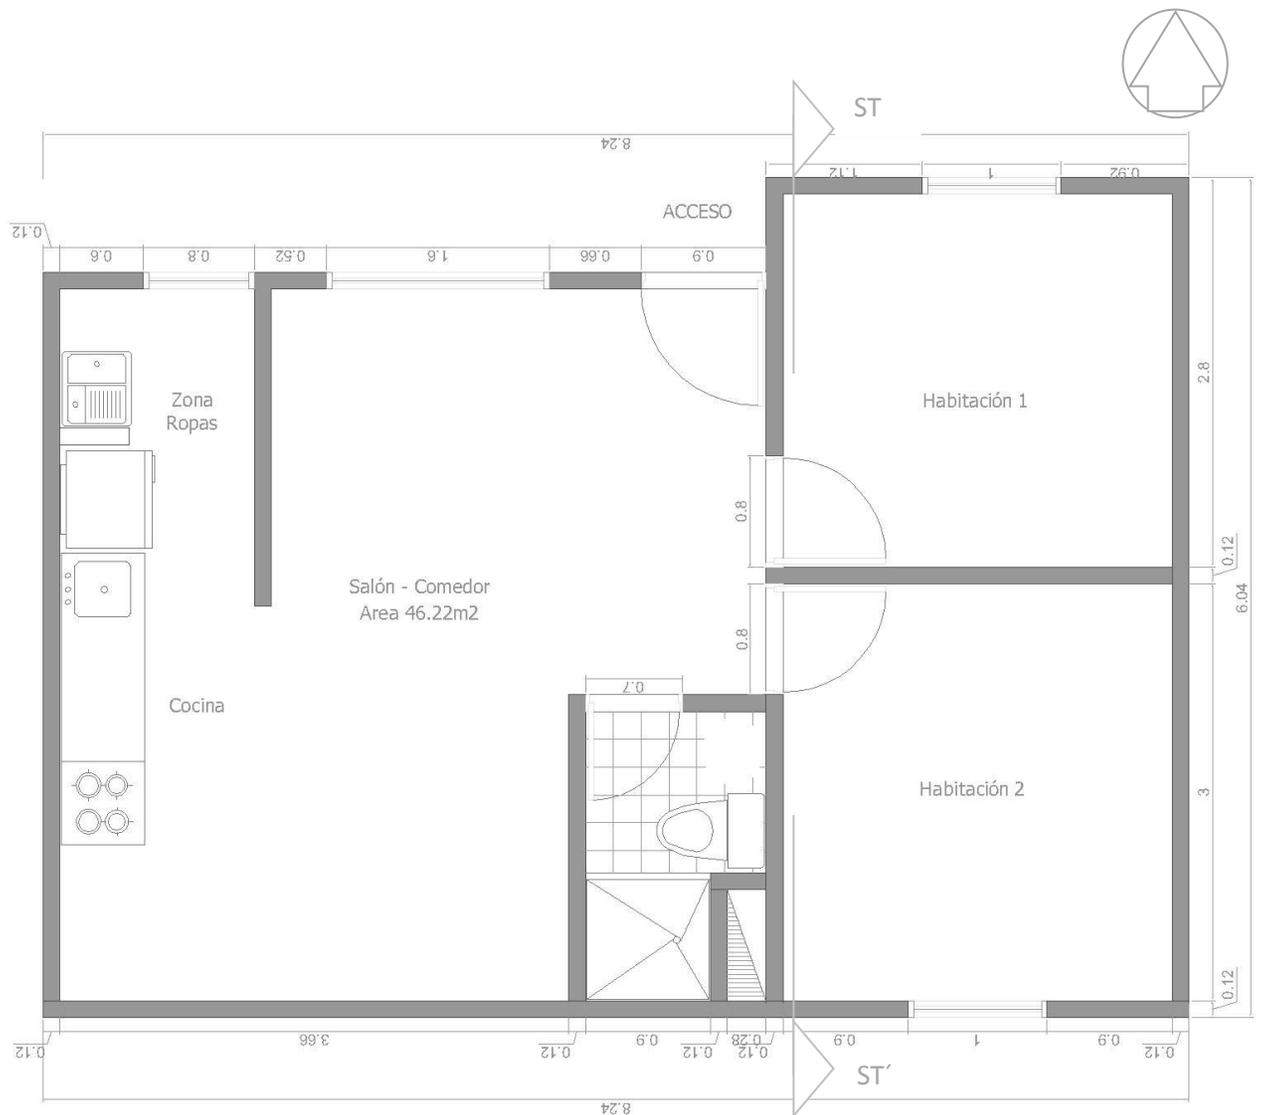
Planta arquitectónica. Vivienda Unifamiliar.
